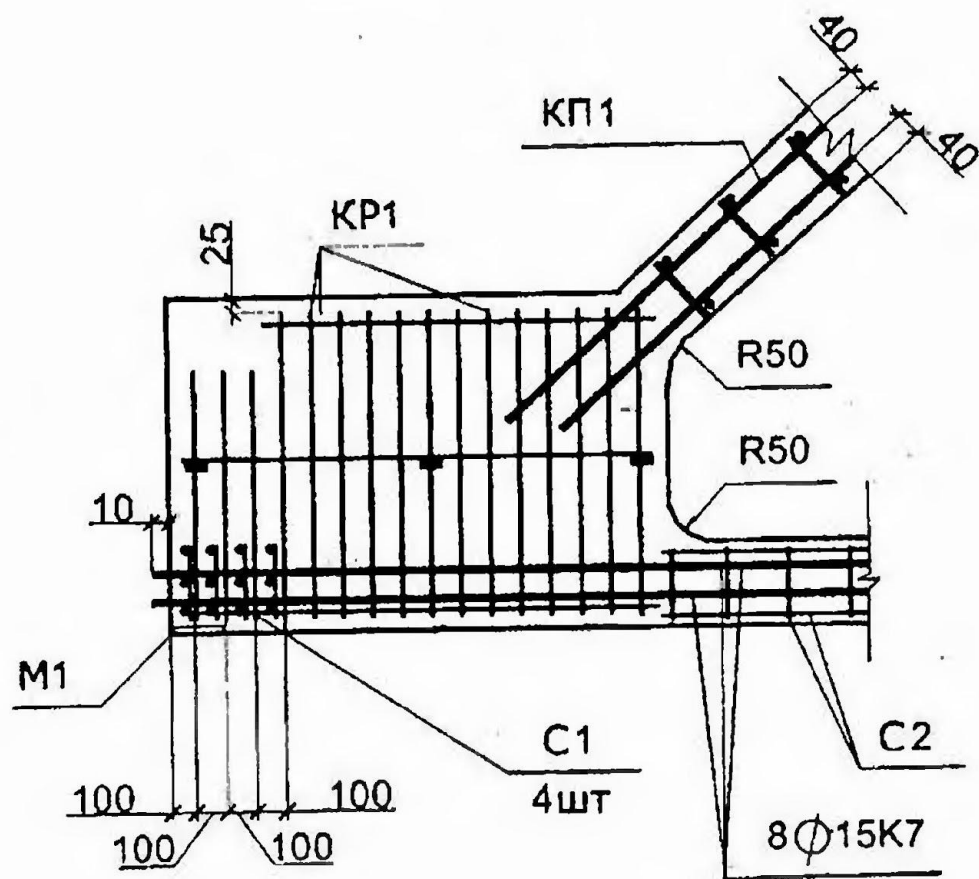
Армирование безраскосной фермы пролетом 24 м
